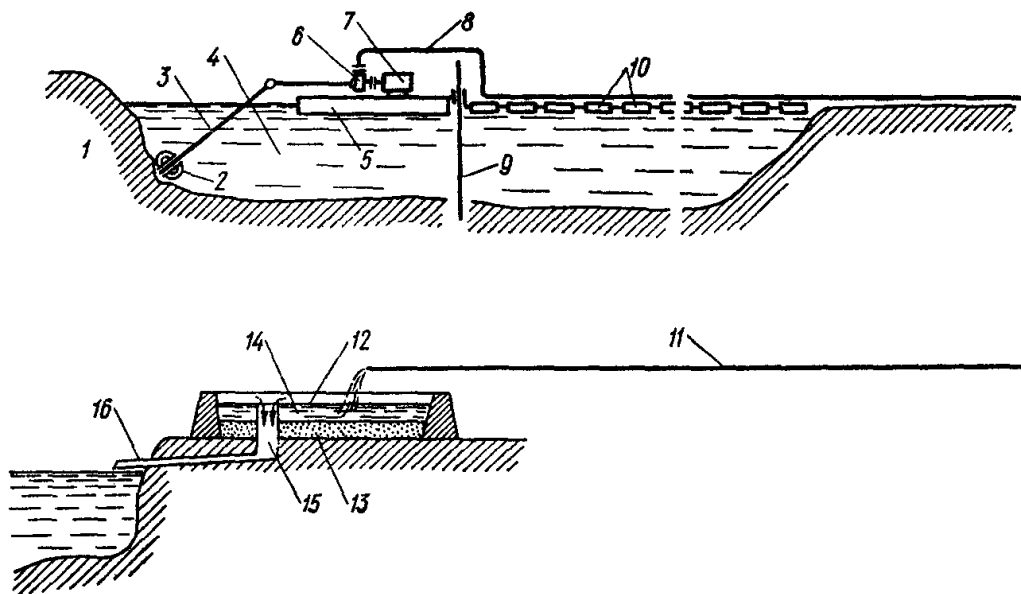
Общая схема земснарядной разработки грунта: 1 – забой; 2 – рыхлитель; 3 – всасывающее устройство; 4 – водоем; 5 – понтон; 6 – грунтовой насос; 7 – двигатель грунтового насоса; 8 – напорный пульповод; 9 – свайный аппарат; 10 – поплавки для удержания пульповода; 11 – сухопутная часть пульповода; 12 – карта; 13 – осевший грунт; 14 – осветленная вода; 15 – шандорный колодец; 16 – лоток для сбора осветленной воды
